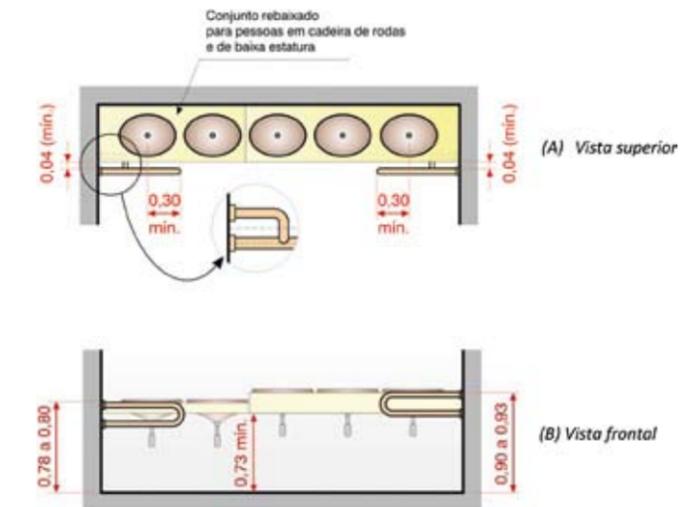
(A e B) - Dimensionamento de barras de apoio em lavatórios coletivos
